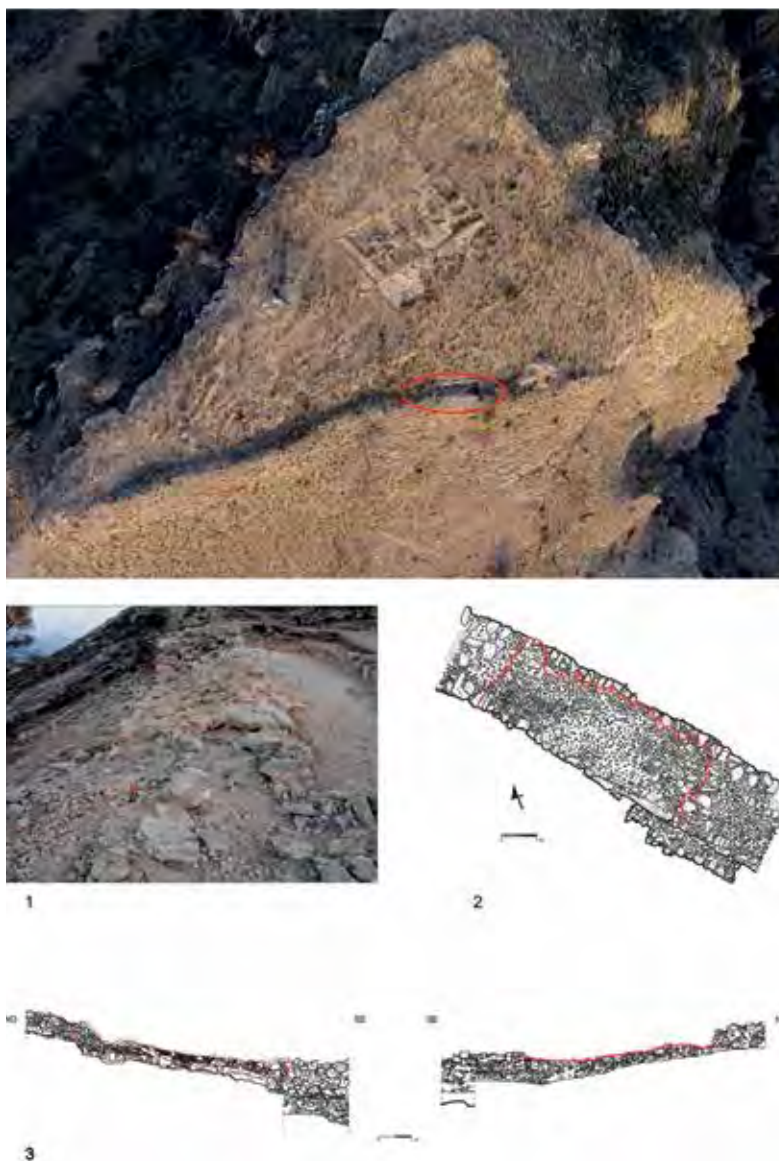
Vista aérea del yacimiento. 1. Imagen de la rotura durante los trabajos de limpieza y excavación. 2. Planta del tramo de muralla intervenido (en rojo la línea de rotura). 3. Alzados intramuros y extramuros del mismo tramo (en rojo la línea de rotura).
